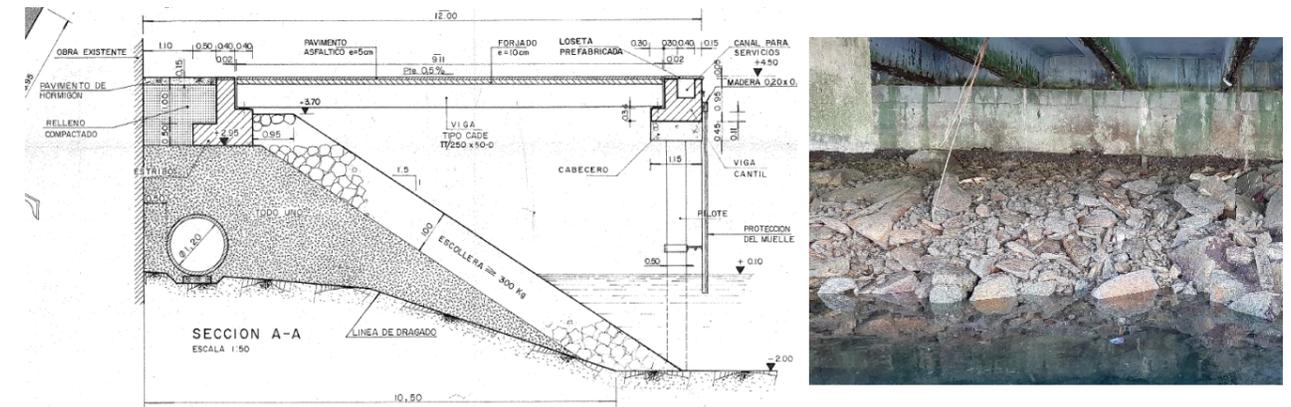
Imagen de la sección tipo del proyecto original (izquierda) y estado actual del apoyo de la viga trasera (derecha)
